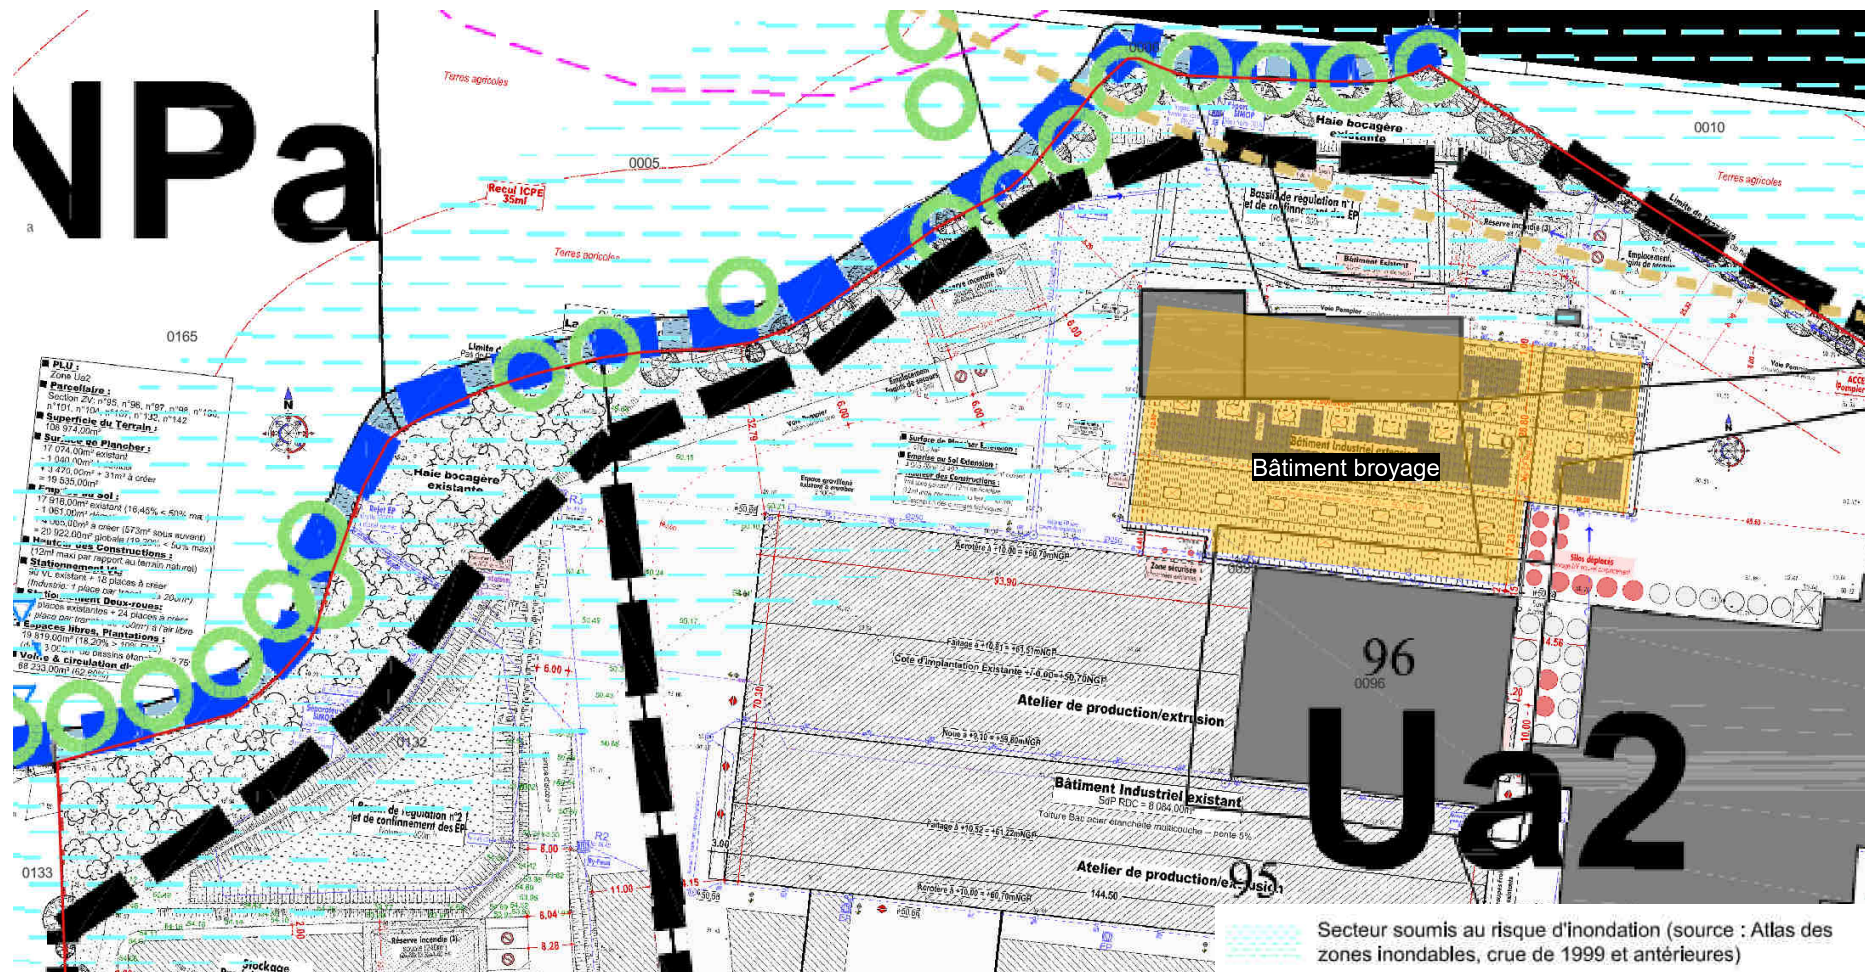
Superposition du plan masse du projet et du secteur soumis à risque d'inondation du PLU (Source : PLU de Bais)
